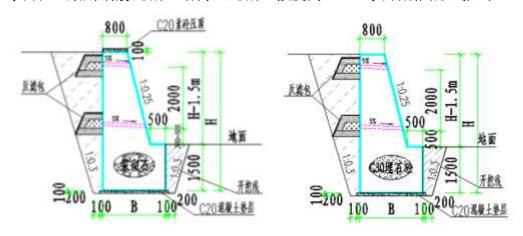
挡墙断面图 (浆砌石挡墙)
